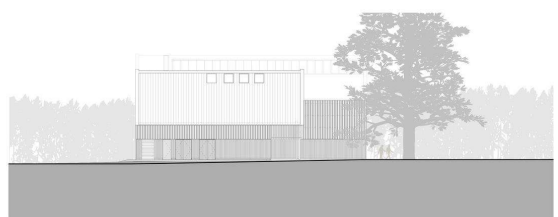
Fachada norte de Escuela de Arte y Diseño Bedales
